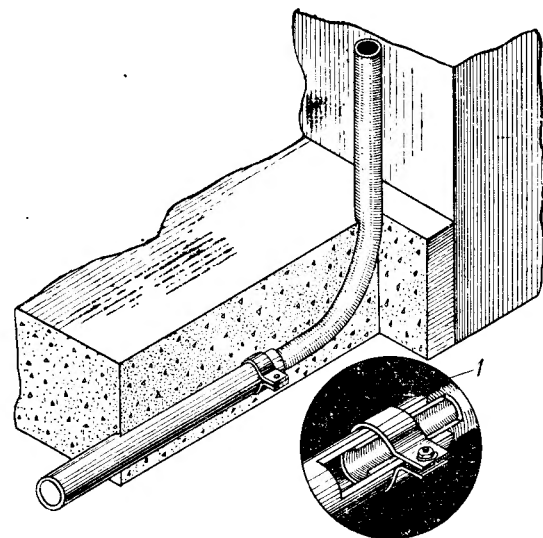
Вывод полиэтиленовой трубы из фундамента или пола с помощью колена из стальной трубы.
